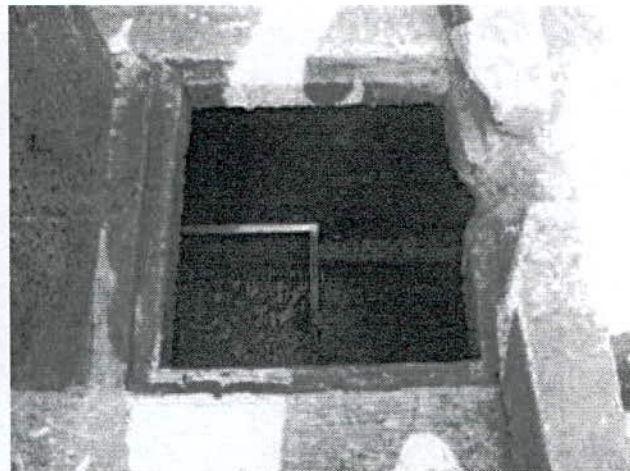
ETE Horto - Poço de Sucção da EEE
